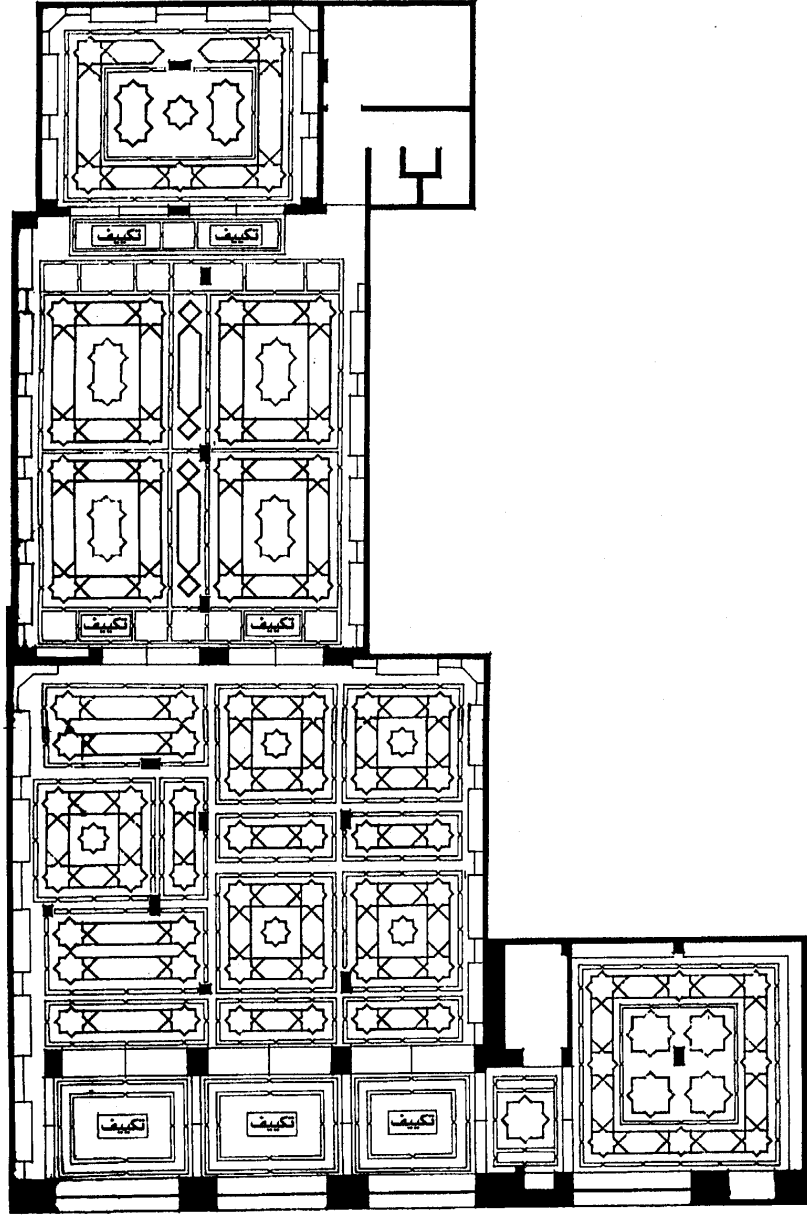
مسقط أفقي لسقف خشبي لمحل سياحي بالأقصر (تصميم المؤلف)
